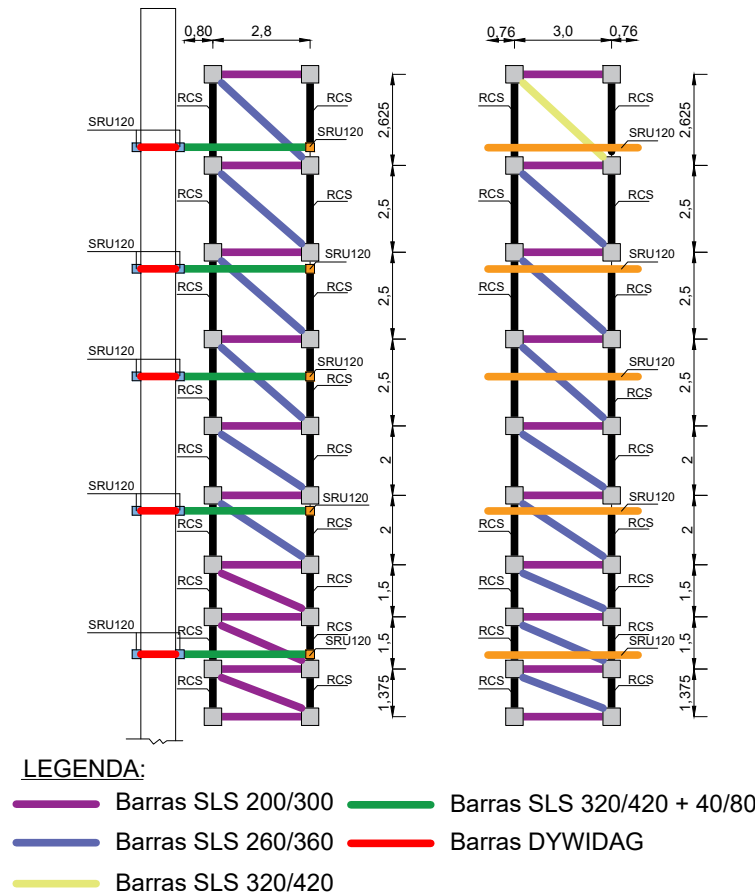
Estrutura de contenção de fachada: Ilustração. (a) Plano perpendicular à fachada; (b) Plano paralelo à fachada
